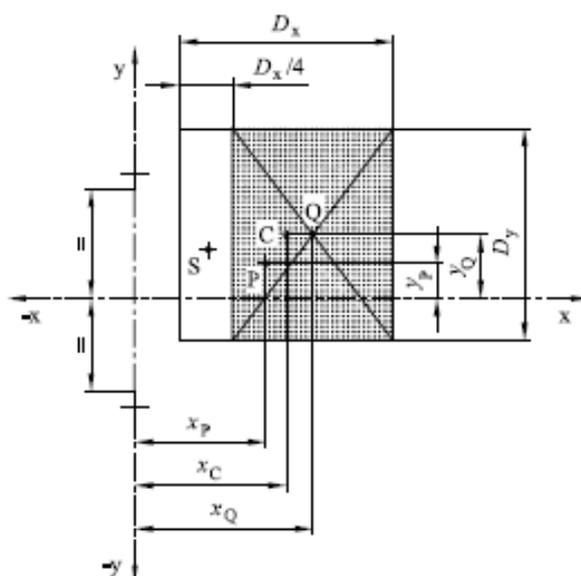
Posizione della cabina rispetto alle guide e direzione delle forze sulle guide (estratto dalla norma EN81.1)
